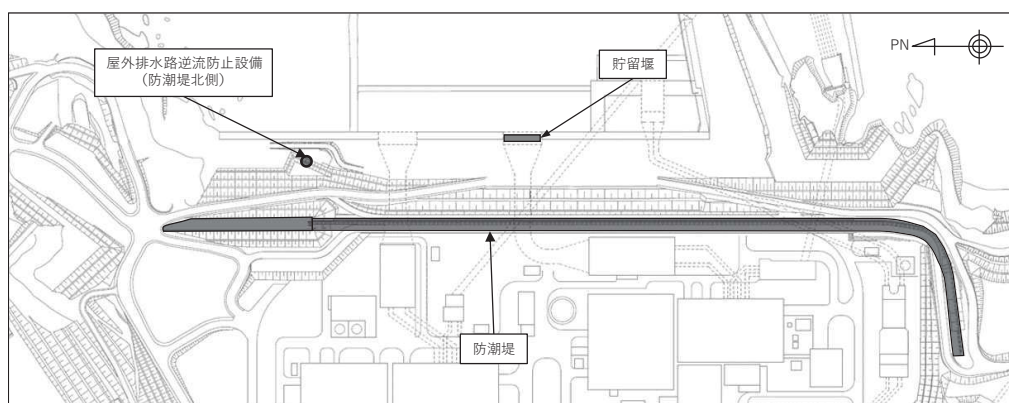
漂流物による衝突荷重を考慮する津波防護施設
